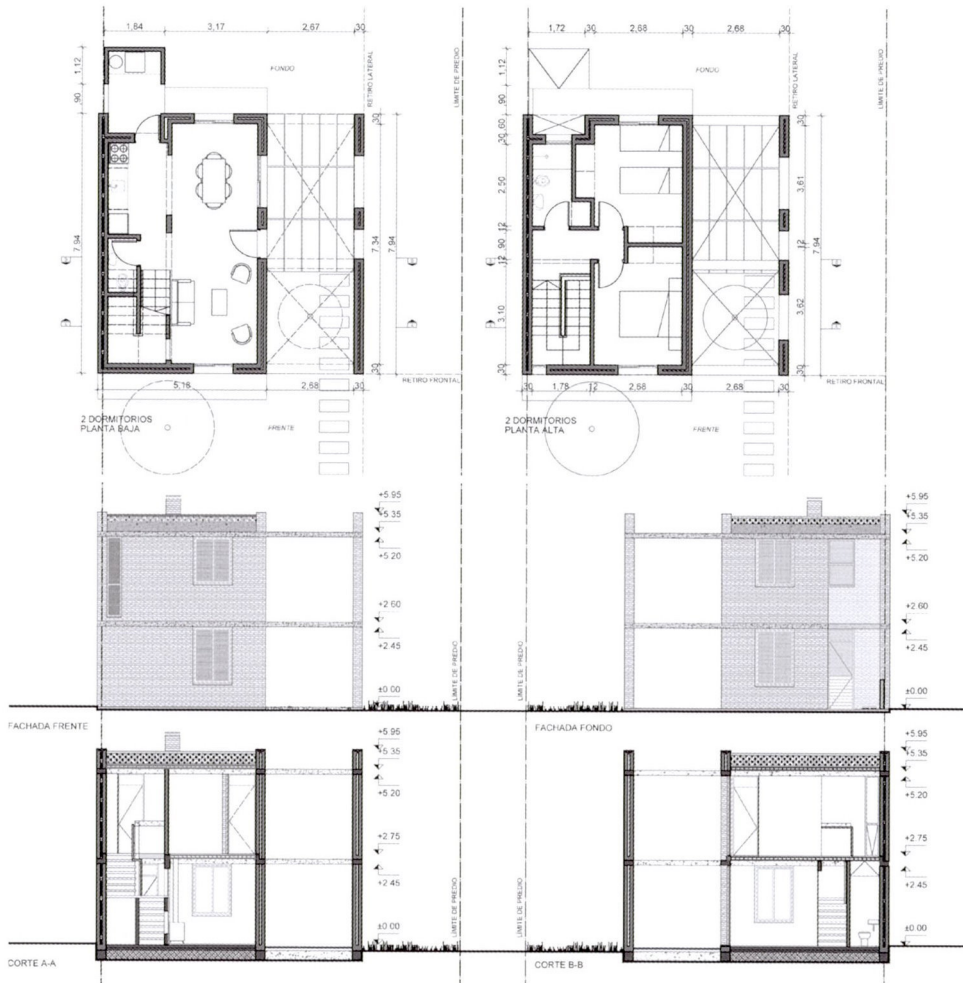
Plantas, cortes y fachadas de las viviendas de 2D.
